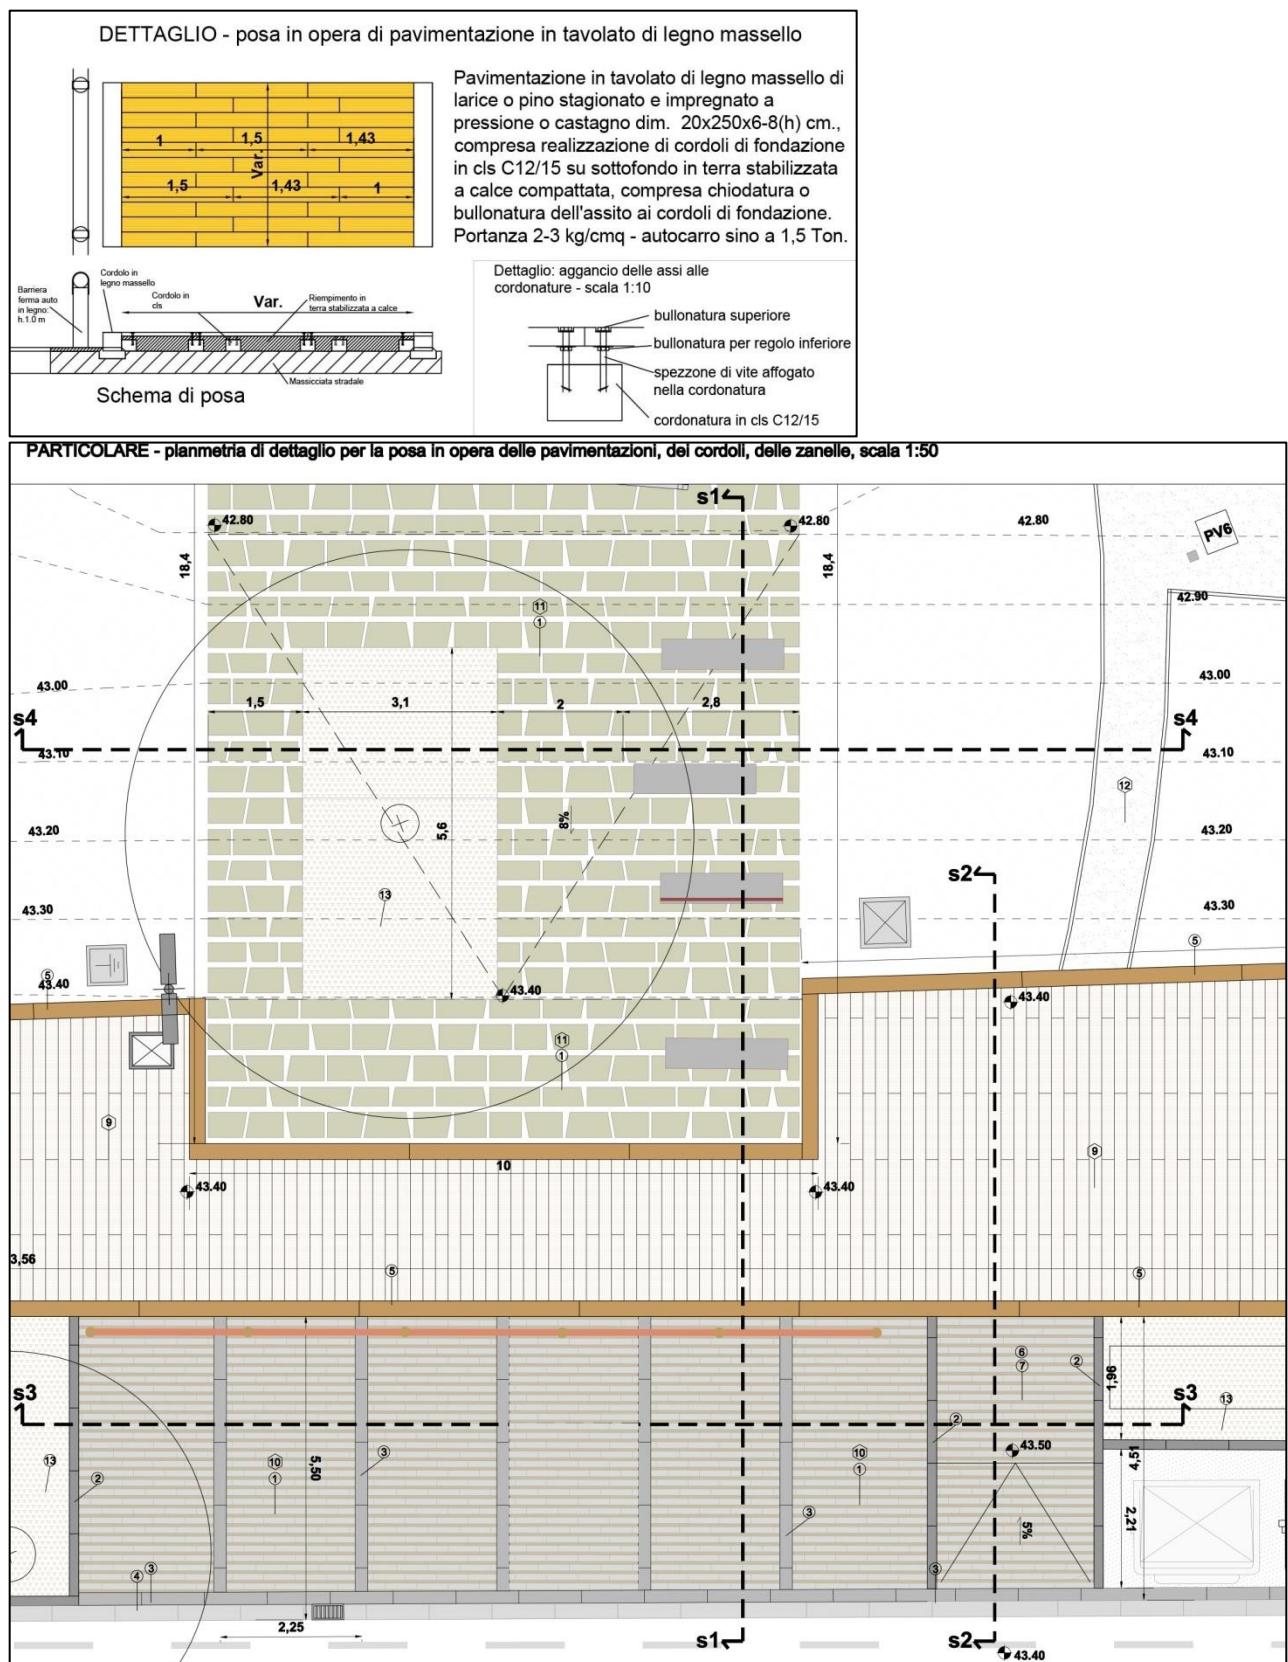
Estratto particolari pavimentazioni di Piazza su via Sant'Angiolo e via A. Doria
